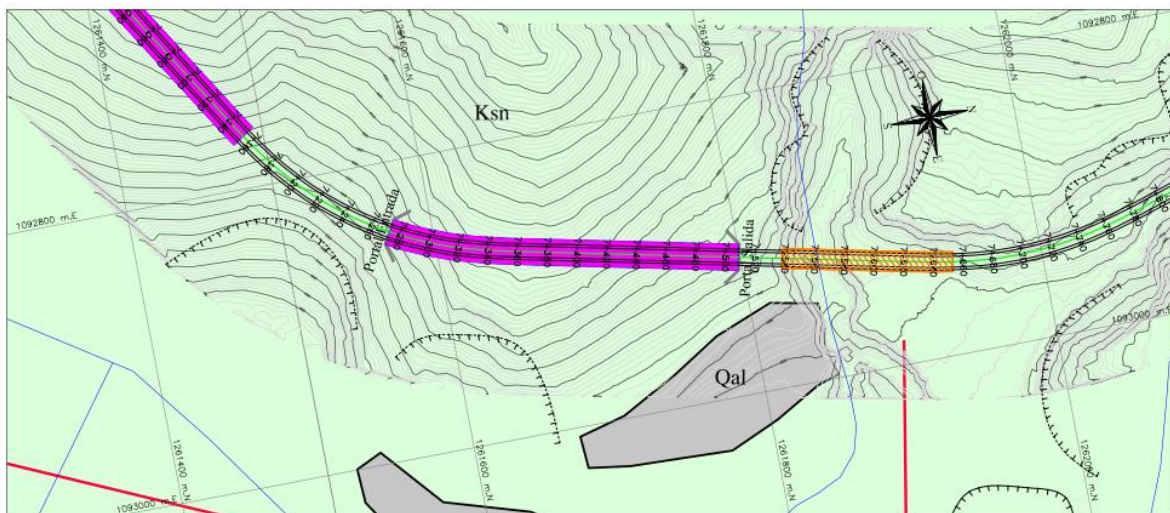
Planta Túnel proyectado entre Uramita y Dabeiba
